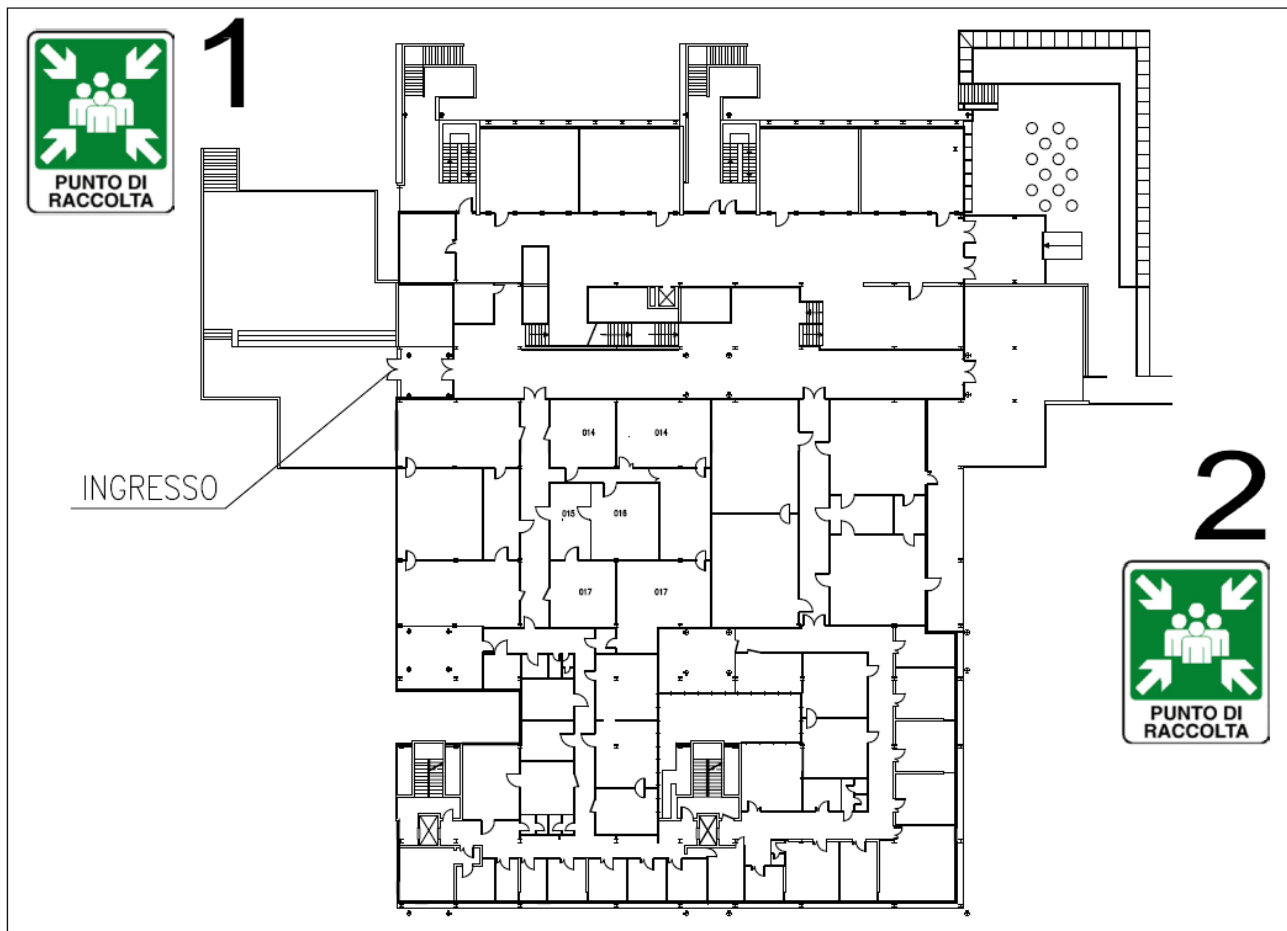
Ubicazione dei punti di raccolta del Plesso -- Stralcio delle planimetrie di emergenza.
